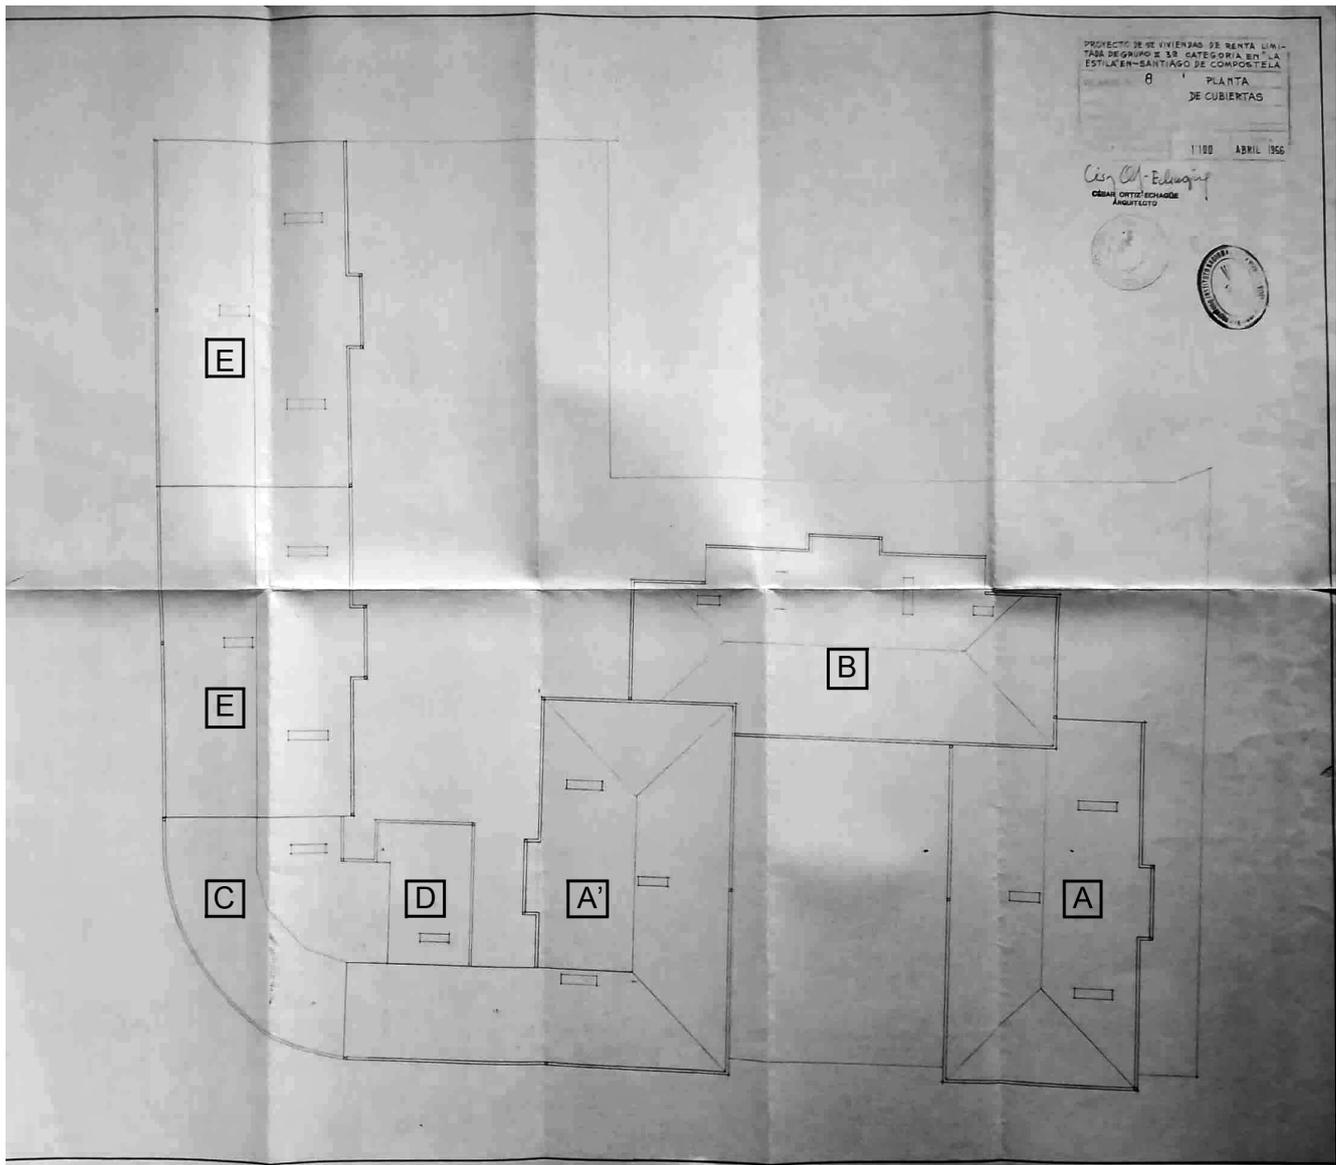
Plano N° 8. Planta de cubiertas, abril 1956. Las letras enmarcadas son del autor.
